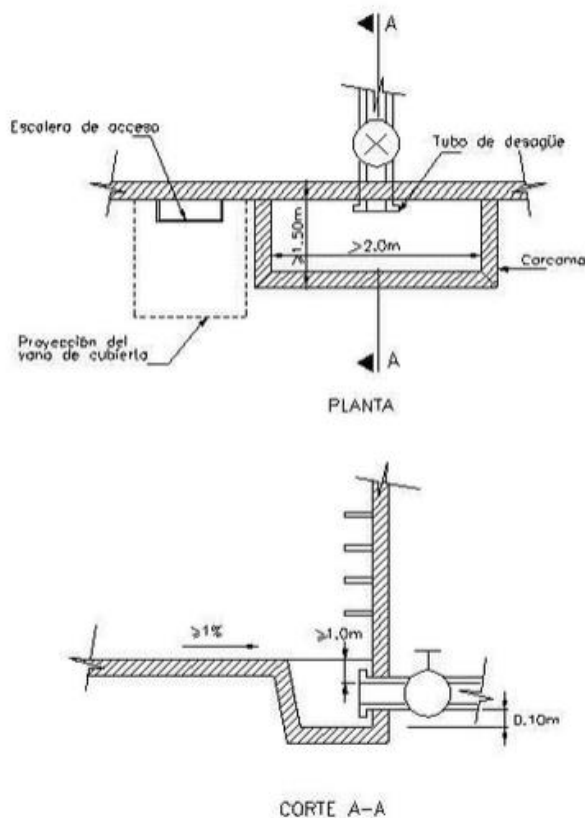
Sistema de drenaje en tanques de almacenamiento, sugerido por la EAAB.
